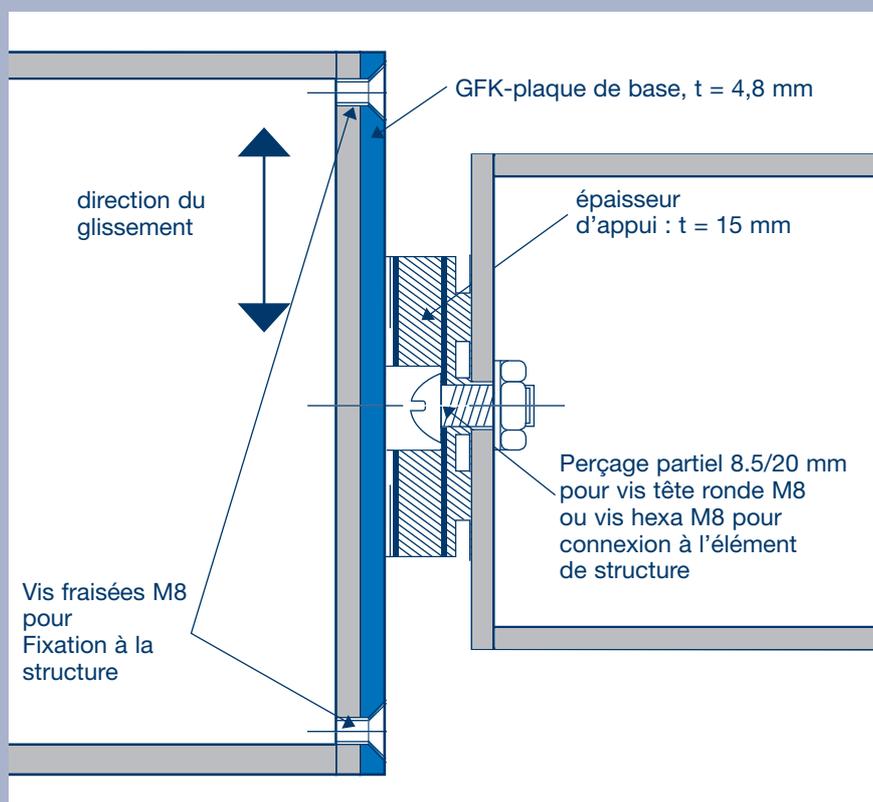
Exemple d'installation de Ciparall® ST, t = 20 mm, en jonction verticale joint entre deux éléments de structure acier avec connexion des composants de l'appui sur la structure.
